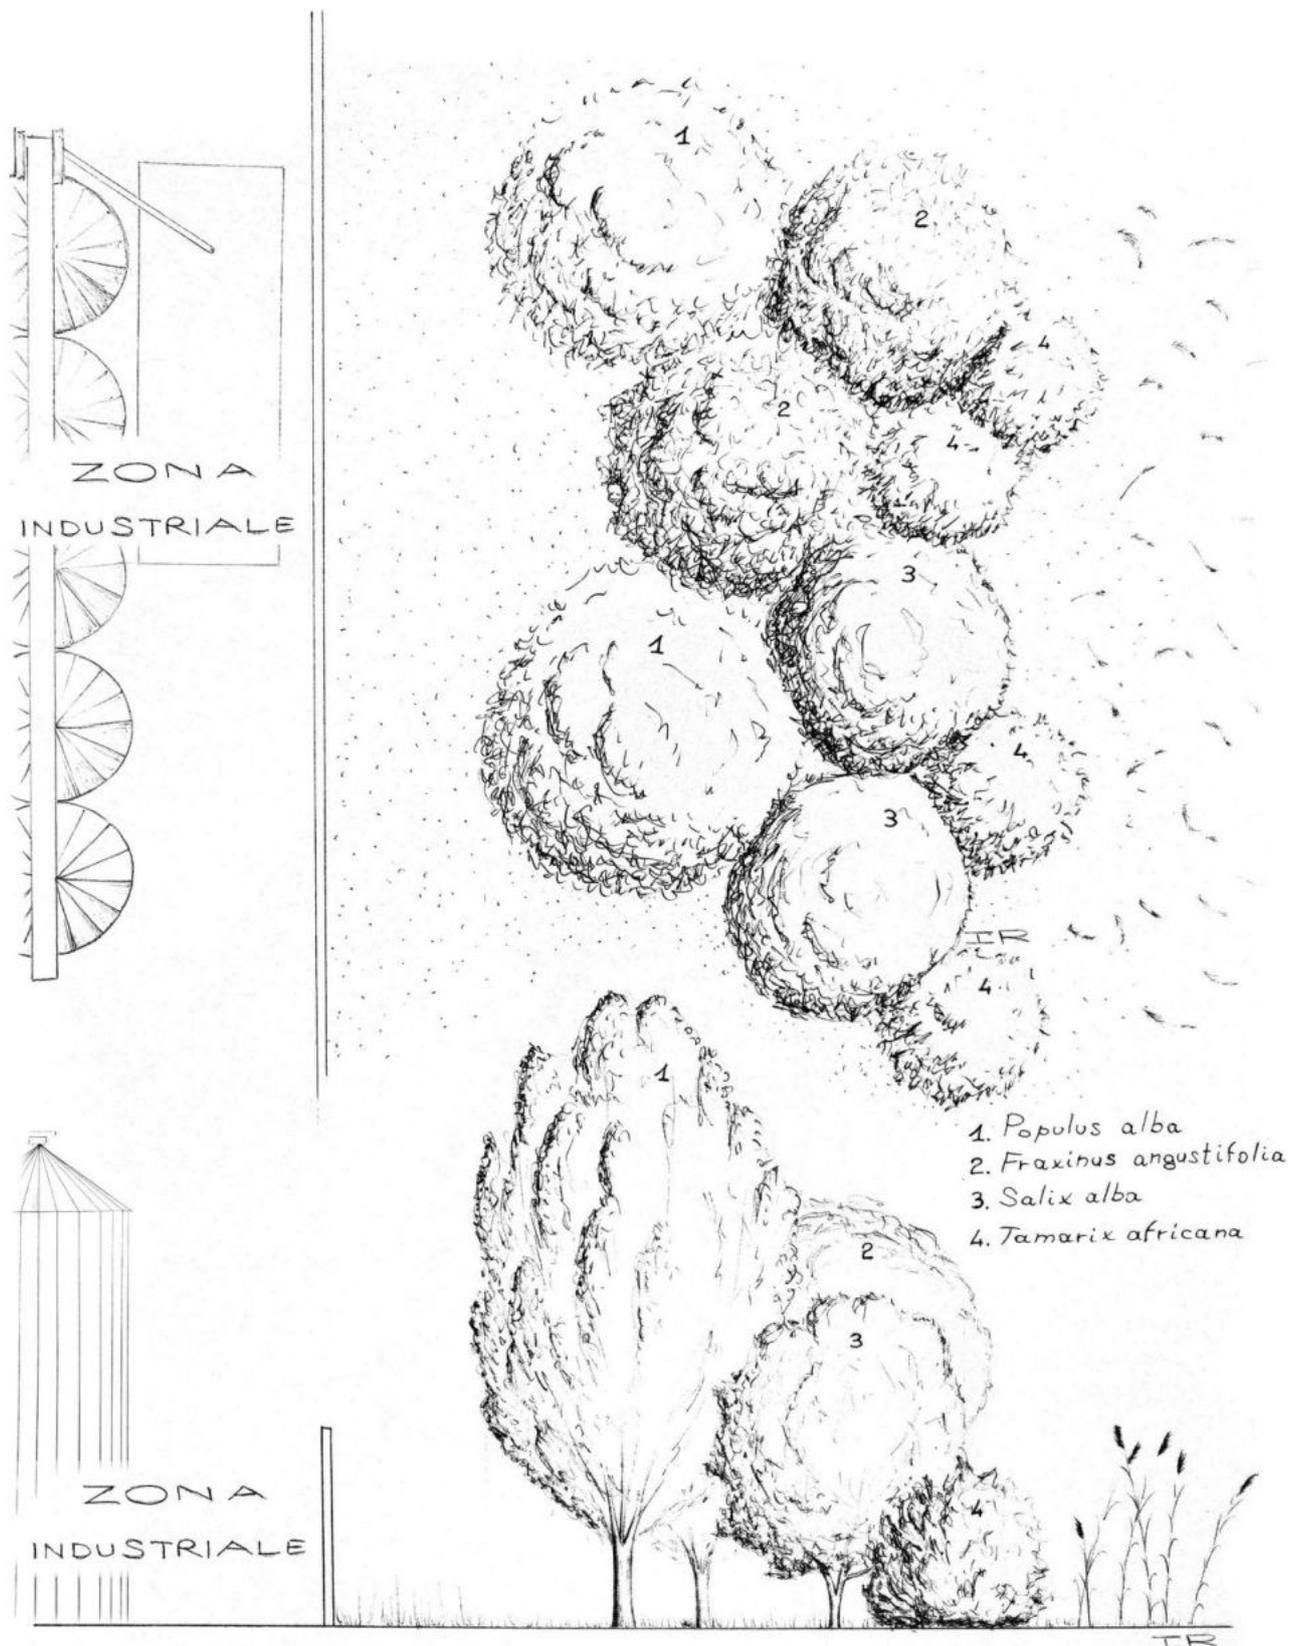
Schema generale di un tratto di area filtro (pianta e sezione tipo).
